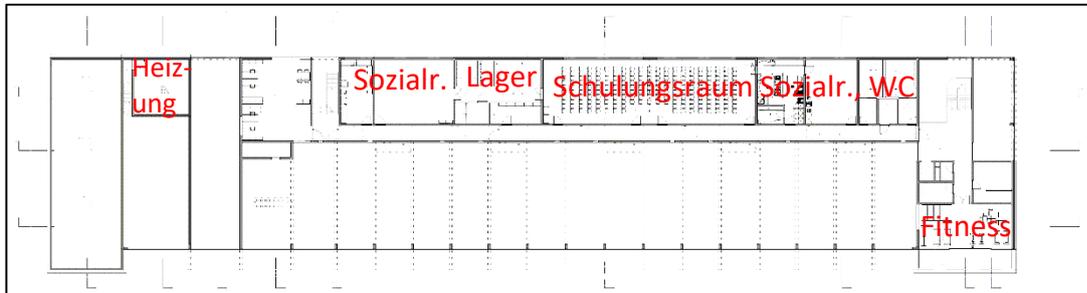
Grundriss Erdgeschoss¹
